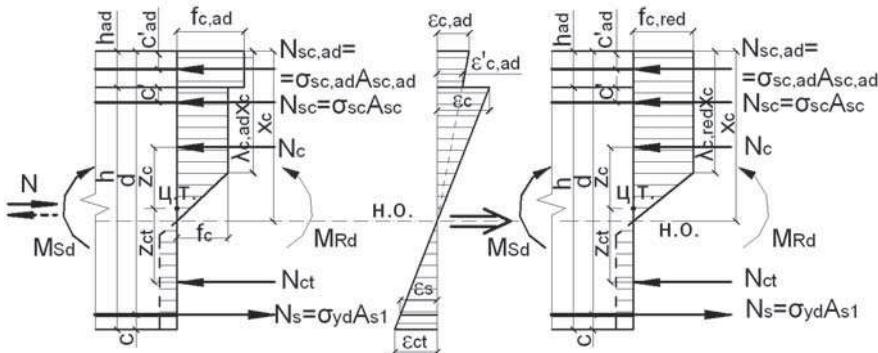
К определению относительных деформаций сжатого бетона и растянутой арматуры: а) эпюра напряжений в сечении усиленного изгибающегося железобетонного элемента; б) эпюра деформаций; в) эпюра напряжений для приведенного значения прочности бетона
